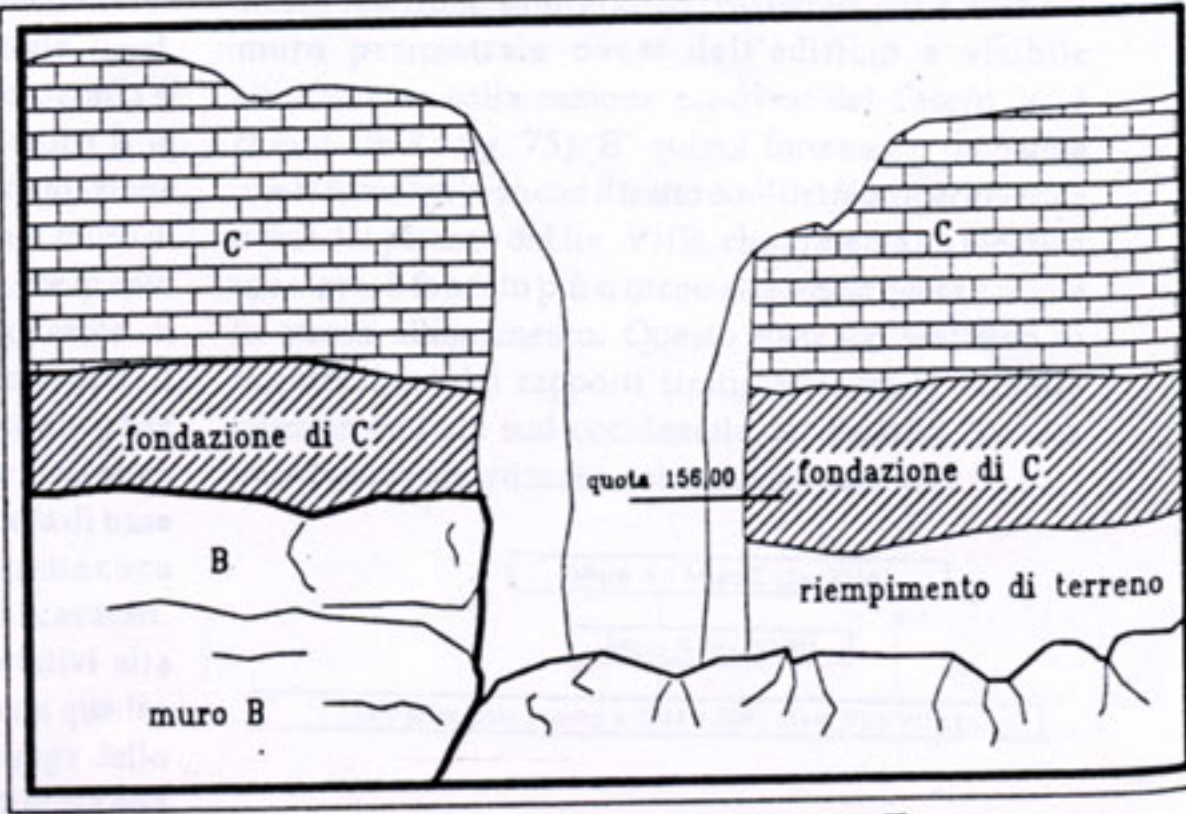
Schizzo ricavato dalla fig. 72 di Megiddo II: si noti la fondazione del muro C che insiste sul muro B.
